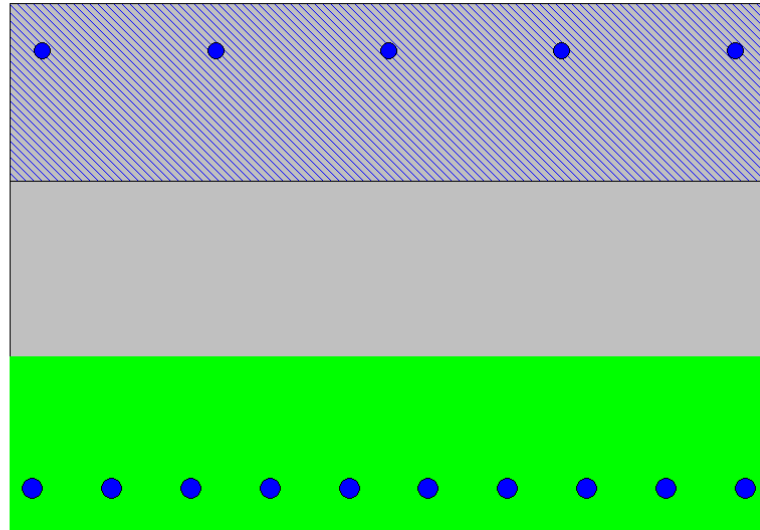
Sezione strutturale 2 – Verifica Fessurazione
